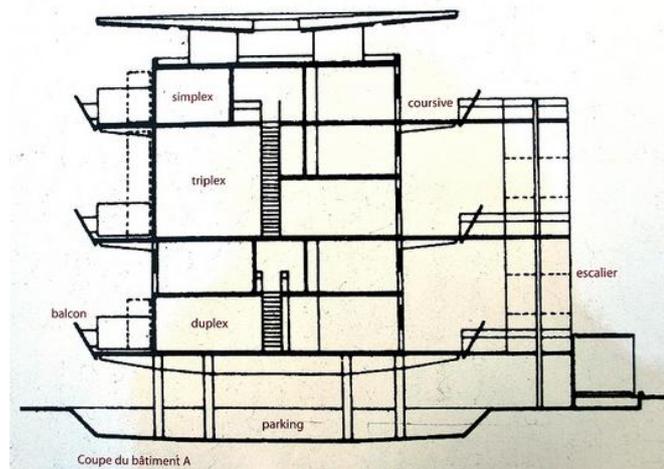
Plantas y cortes arquitectónicos de los departamentos Nemausus 1. Fuente: Urban Design. Newcastle University
